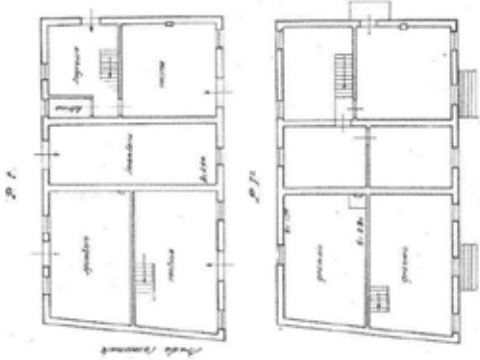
Fabbricato Part. 49. Planimetrie Piano Terra e Piano Primo
